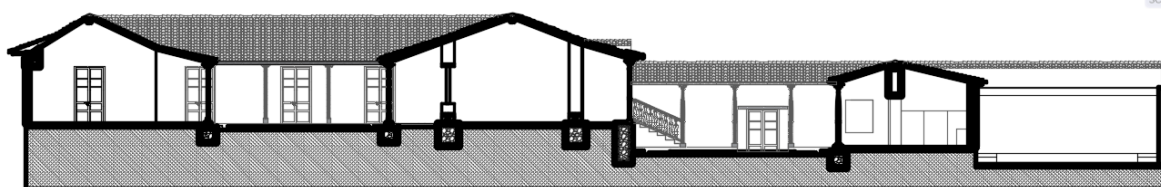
, Corte transversal, Fuente: Autor propio, 2016.
